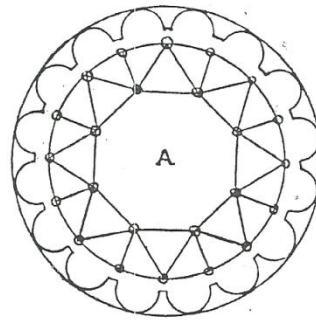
Leonardo da Vinci: Planta de Santa María in Pratica, Pavía.
